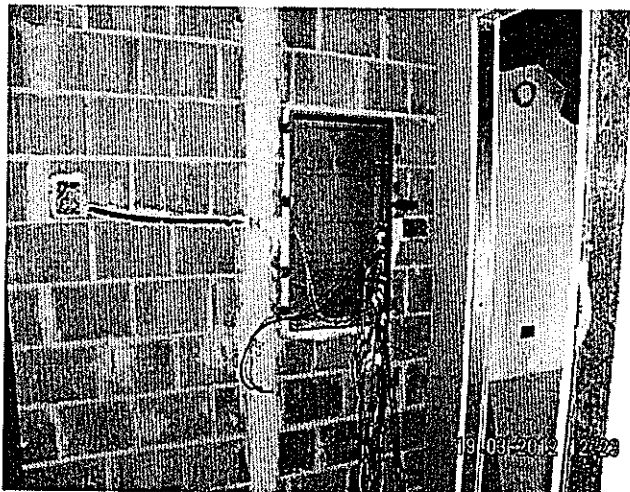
Secondo piano: Ballatoio scale- Quadro elettrico
